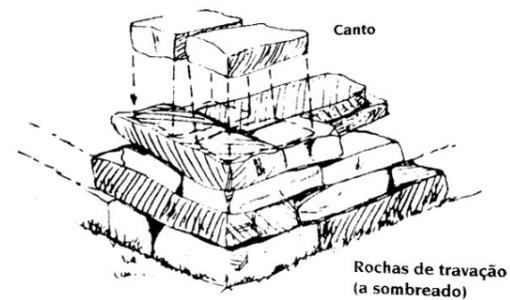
Pormenor do canto do muro com destaque para as pedras de travação. Fonte: Vivian (2011)
